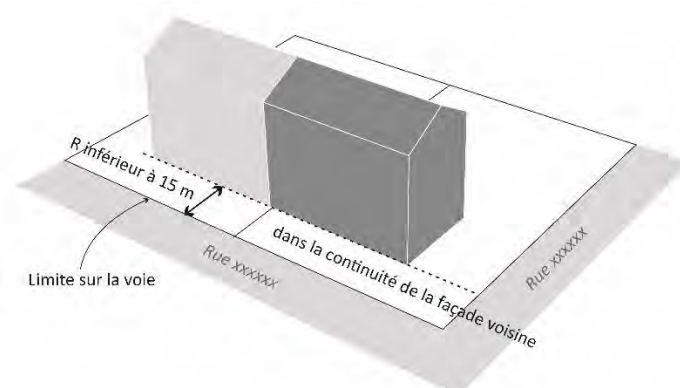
\_ Implantation dans la continuité de la façade voisine
